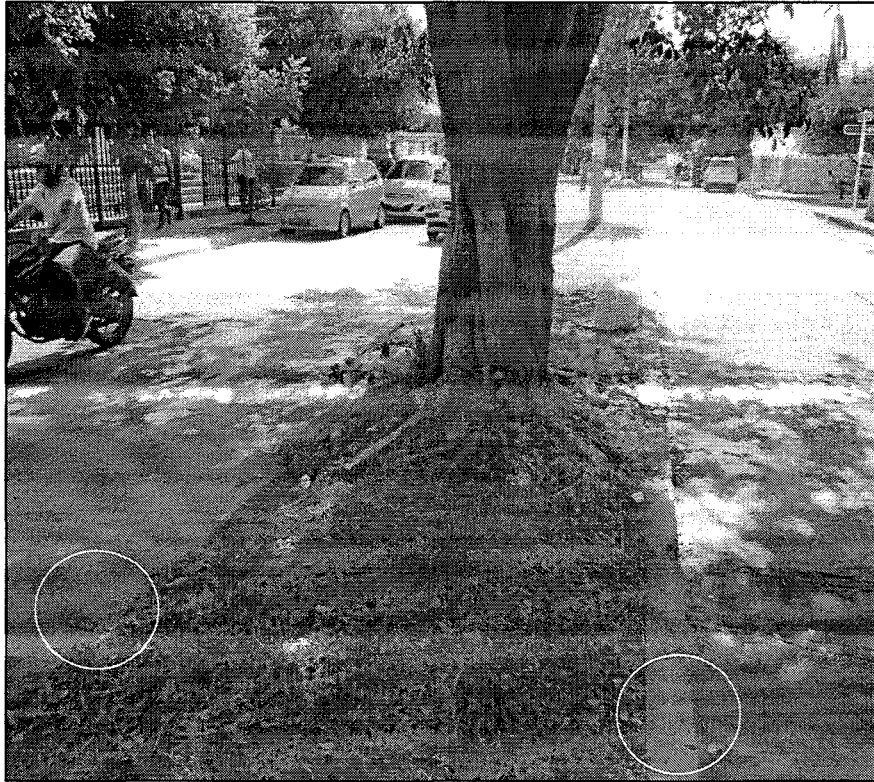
Daños a obra civil pública (Bordillo, fisurado y levantado lado izq)
